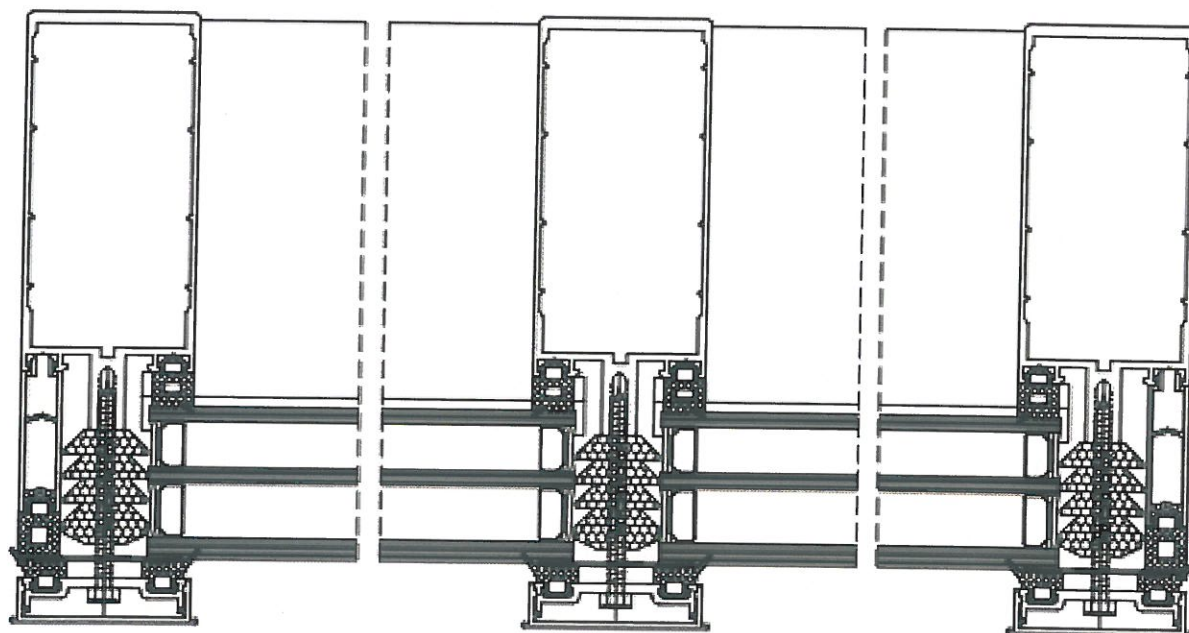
Горизонтальный разрез испытываемой конструкции.
